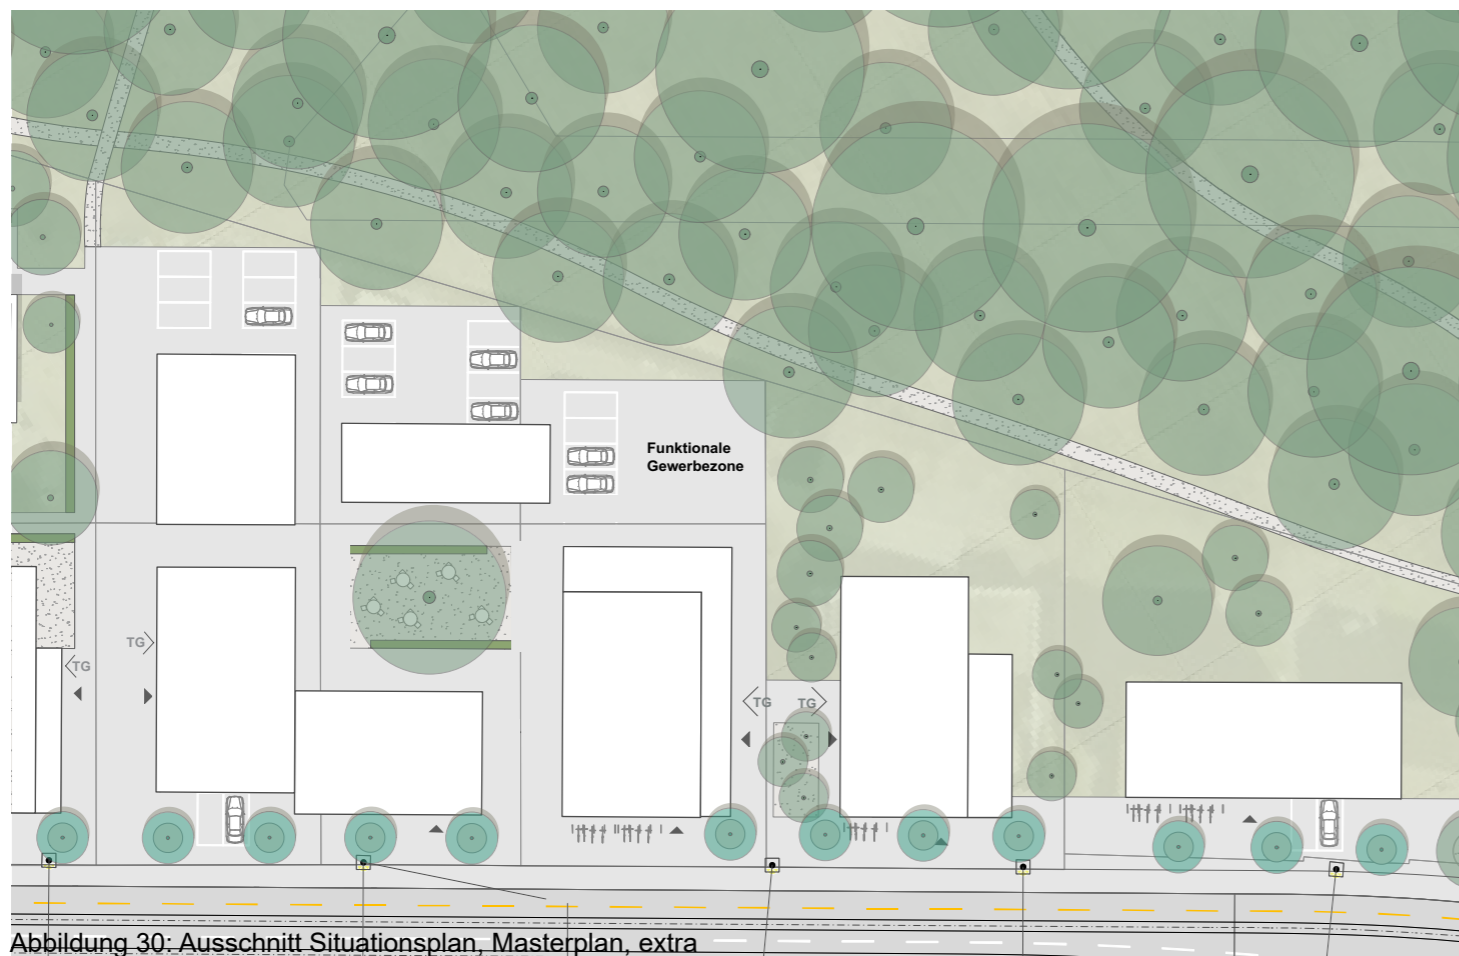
Ausschnitt Situationsplan, Masterplan, extra
